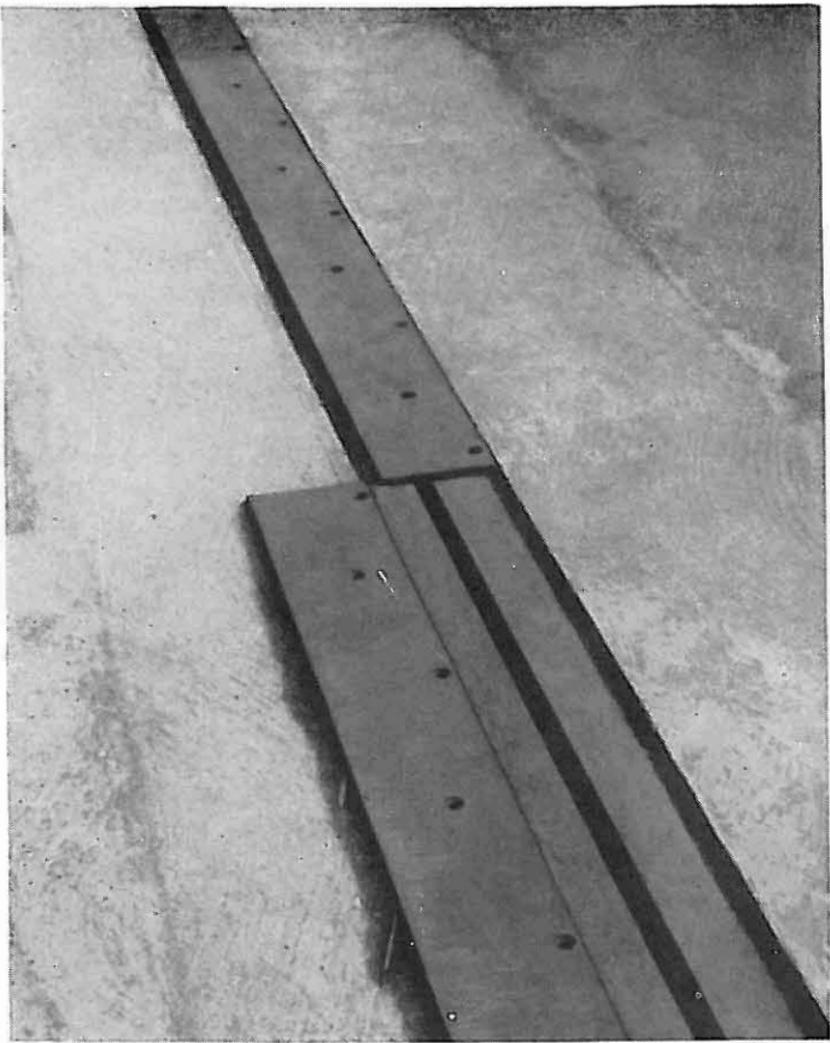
Die Fuge wird durch ein Schleppblech überdeckt (oben). Unten ist das Schleppdach beiseite geschoben, damit man den Fugenspalt sieht
